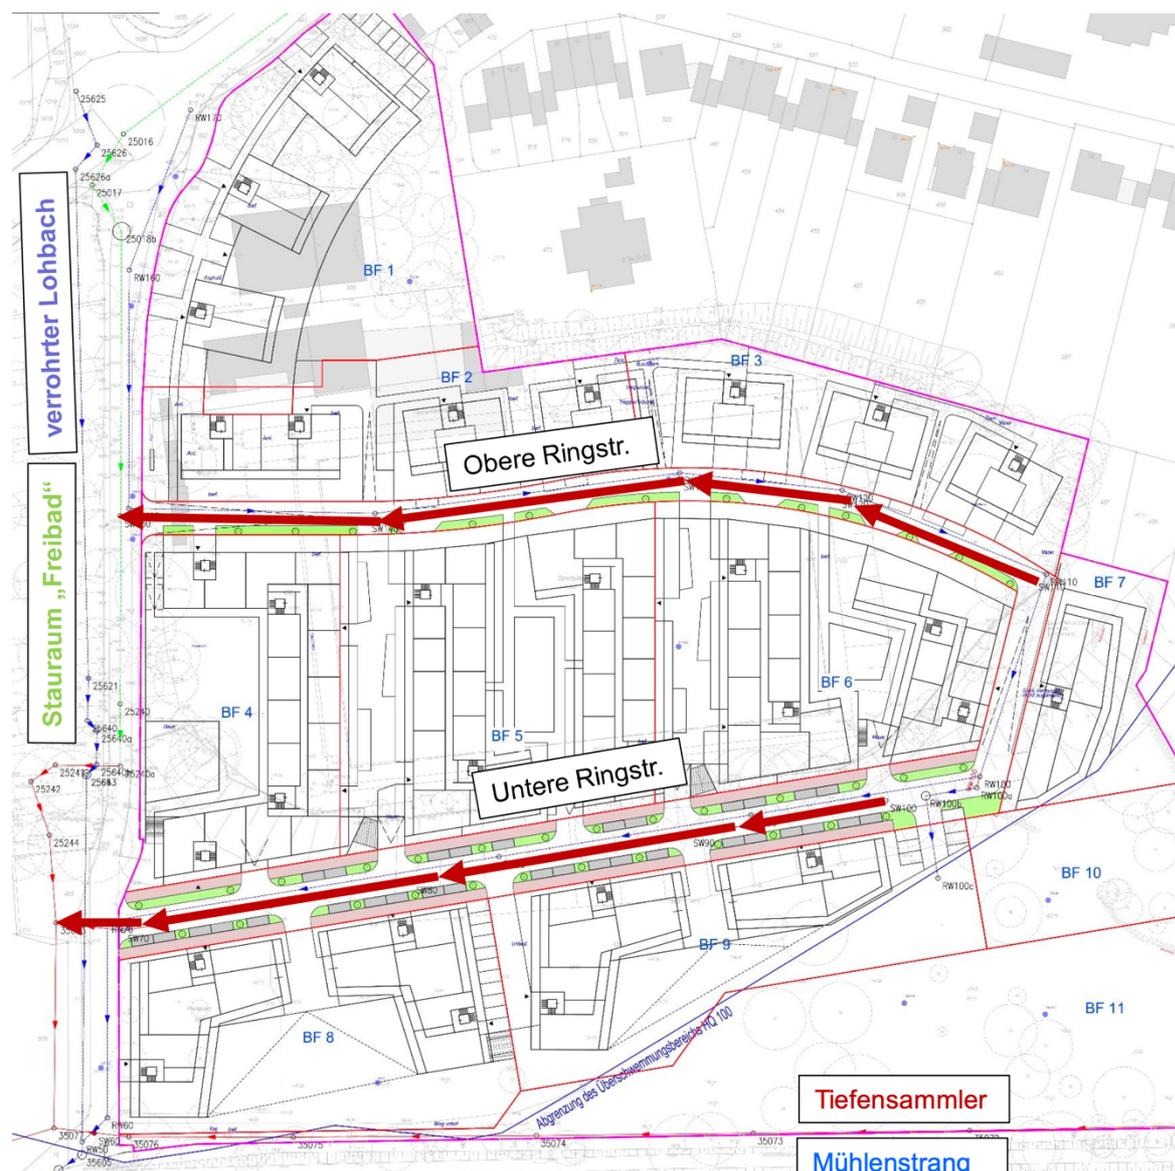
Lageplan- Anfallendes Regenwasser
